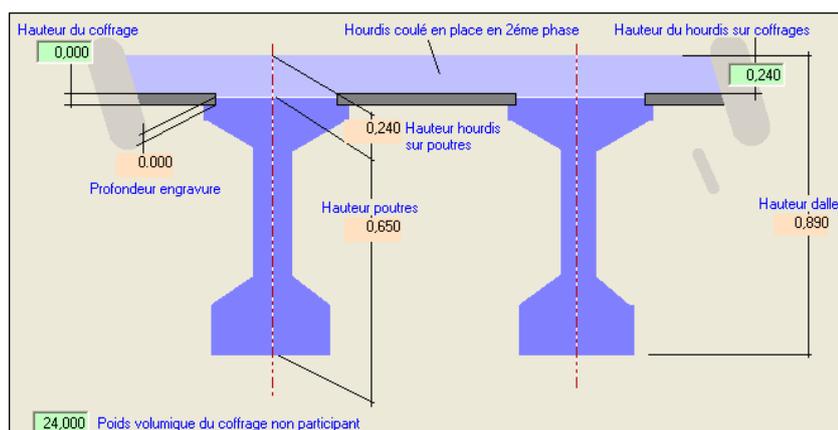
Dimensions du hourdis (ouvrage n°1)
